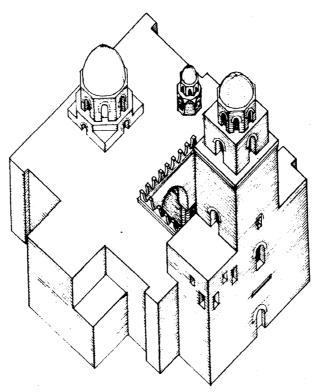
مسقط أفقي للمشهد باسون جنوب مصر (عن: Cresewll).
